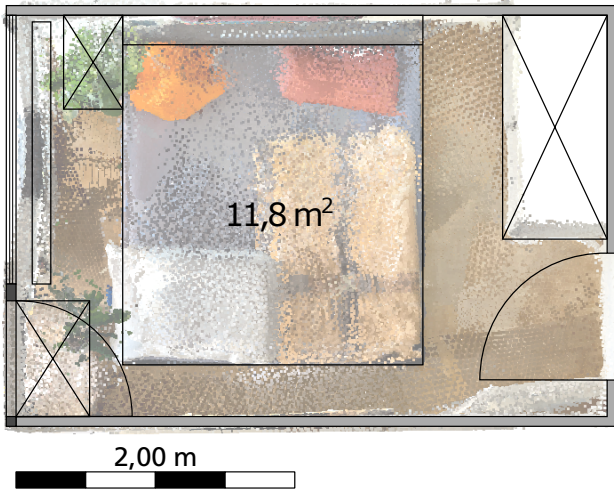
Grundrissdarstellung mit RGB-texturierter Punktwolke eines Schlafzimmers
